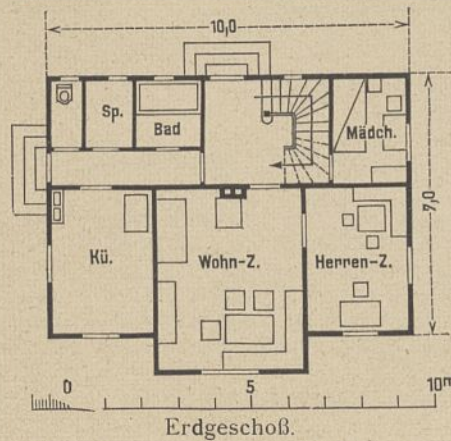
u. 44. Grundrisse zu Abb. 42.
